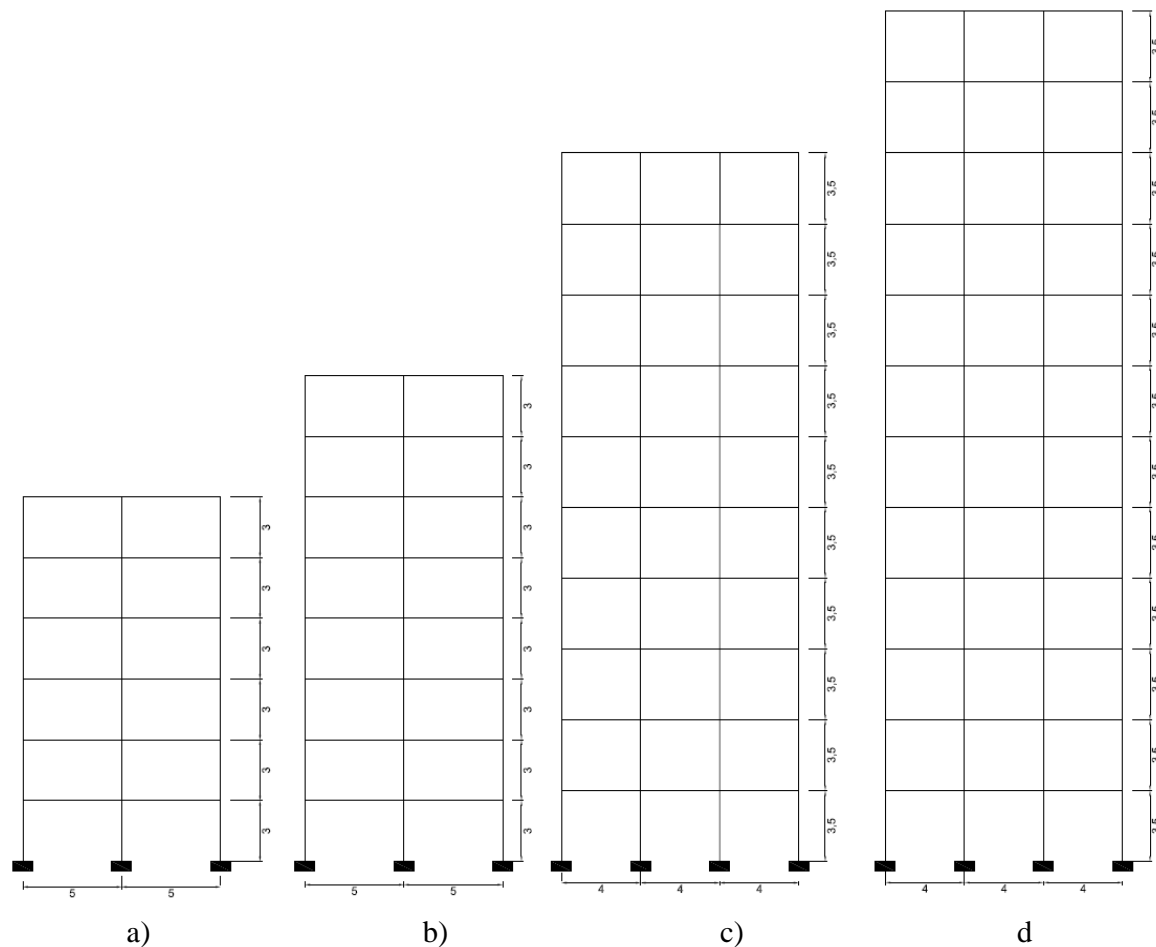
Vista en elevación de las estructuras estudiadas: a) 6 niveles, b) 8 niveles, c) 10 niveles y d) 12 niveles (Sin escala)
